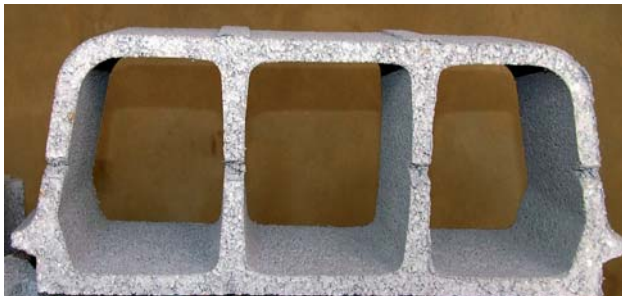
Imagen bovedilla de hormigón prefabricado.
